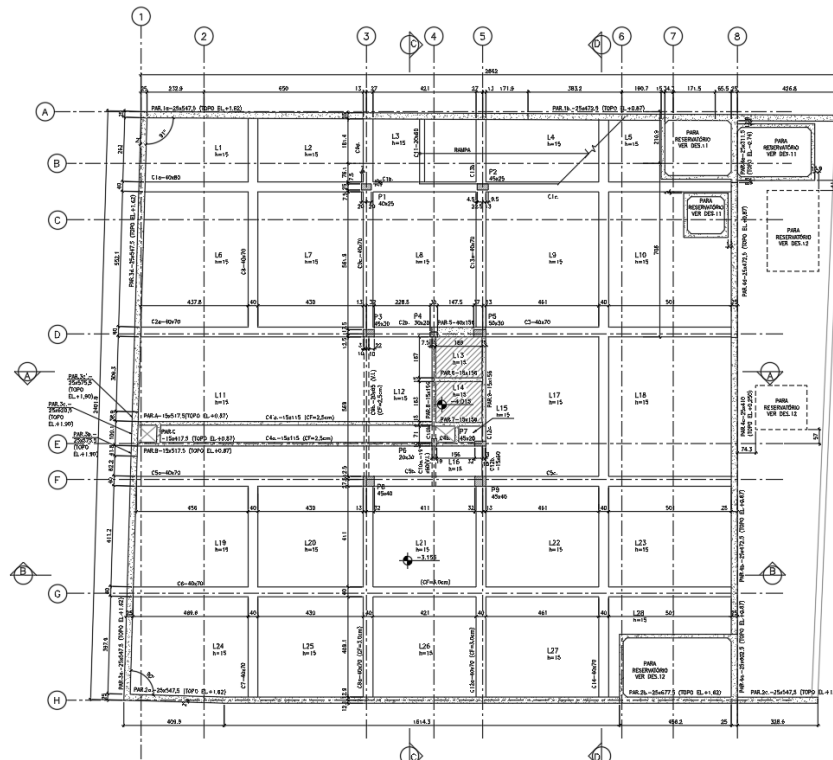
Planta de piso do subsolo [desenho código 02-DPSC-PE-EST-PB-02-R01].
